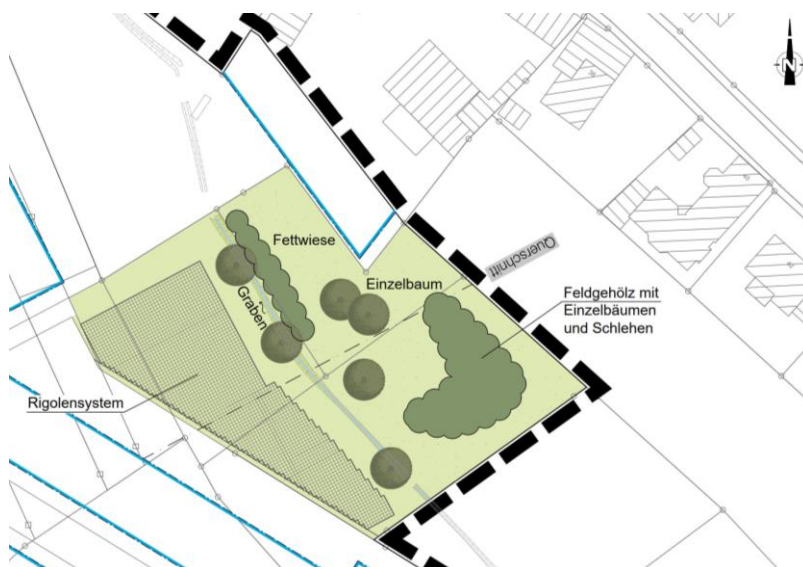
Lageplan Grünfläche am östlichen Planungsrand
